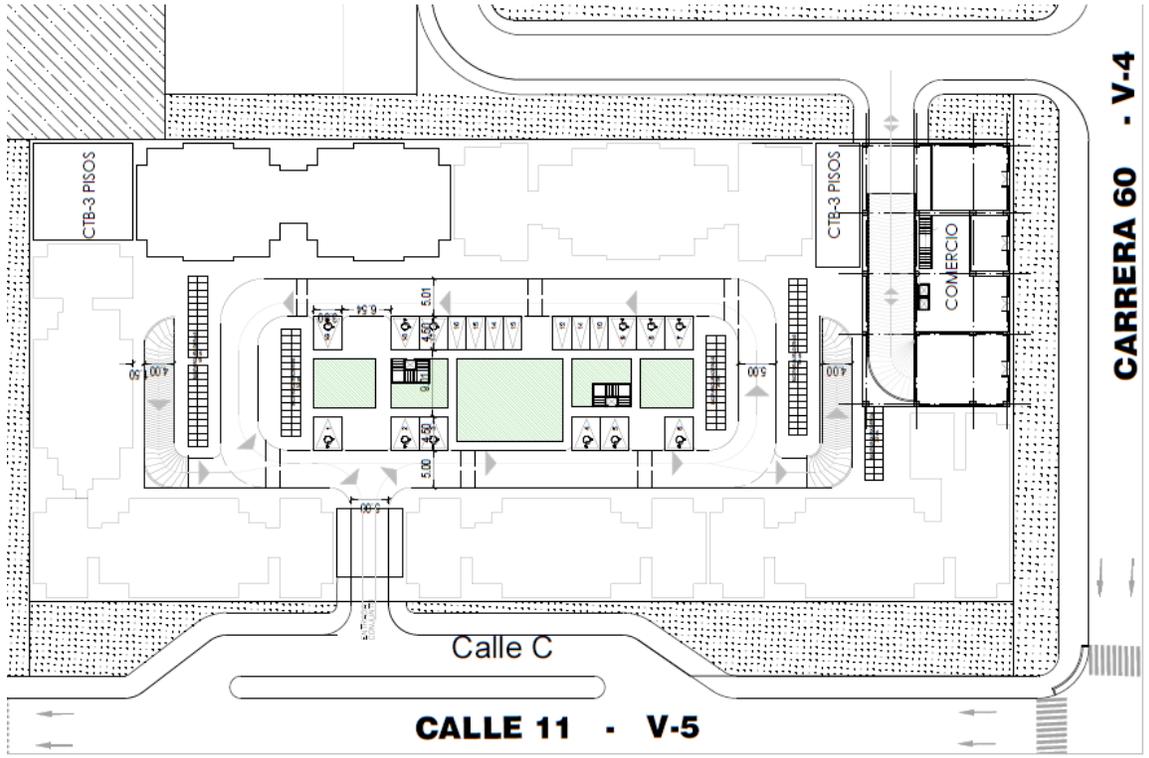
PF13. Planta Eestacionamientos – Primer piso
